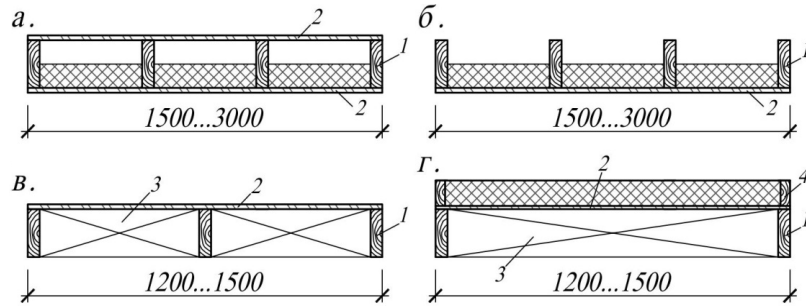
Поперечные сечения совмещенных плит пролетом до 6,0 м: *a* — под рулонную кровлю для отапливаемых зданий; *б* — то же под кровлю из листовых материалов; *в* — для неотапливаемых зданий под рулонную кровлю; *г* — для отапливаемых зданий под кровлю из листовых материалов: 1 — несущие ребра; 2 — обшивки; 3 — диафрагмы жесткости; 4 — обрамляющие элементы
